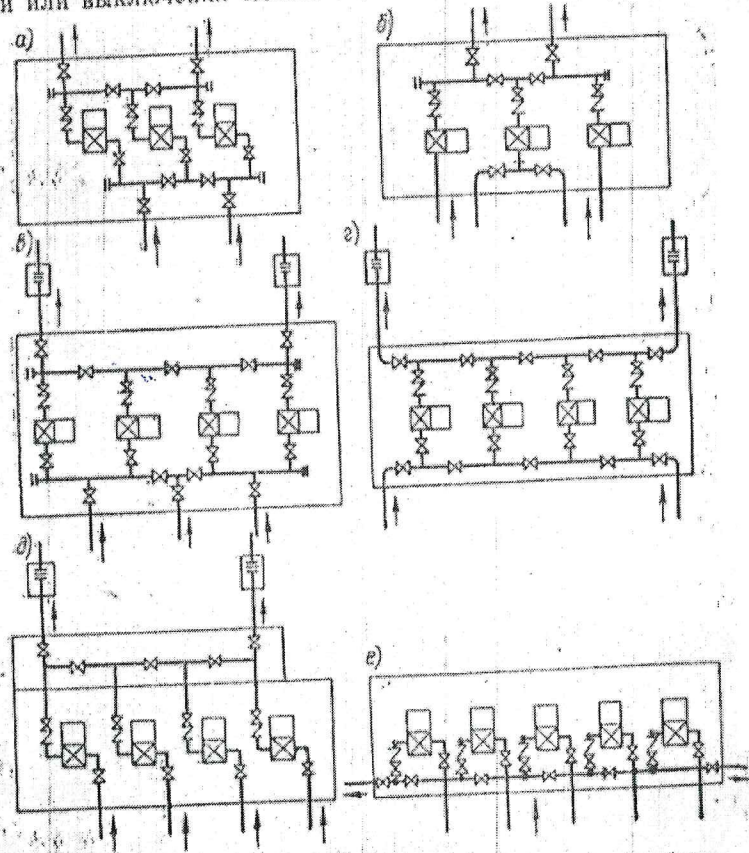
Схемы переключения всасывающих и напорных трубопроводов насосной станции второго подъема
